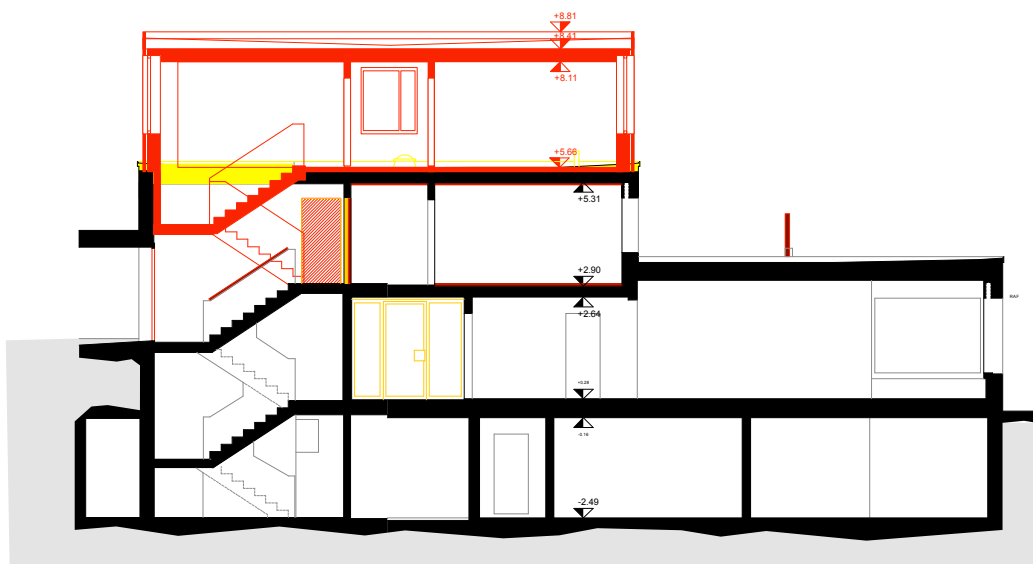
Querschnitt: Gebäude E/Hauswartwohnung (Planstand Bauprojekt 2014)
